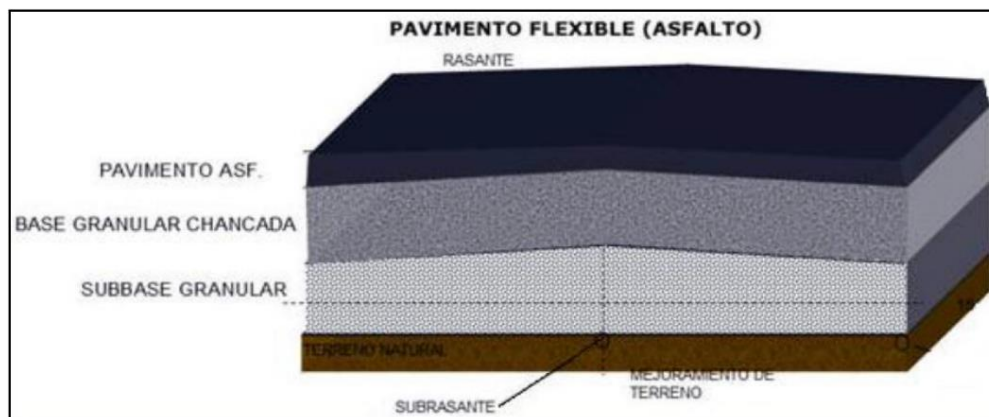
Estructura básica de los Pavimentos Flexibles (Mezcla Asfáltica).
